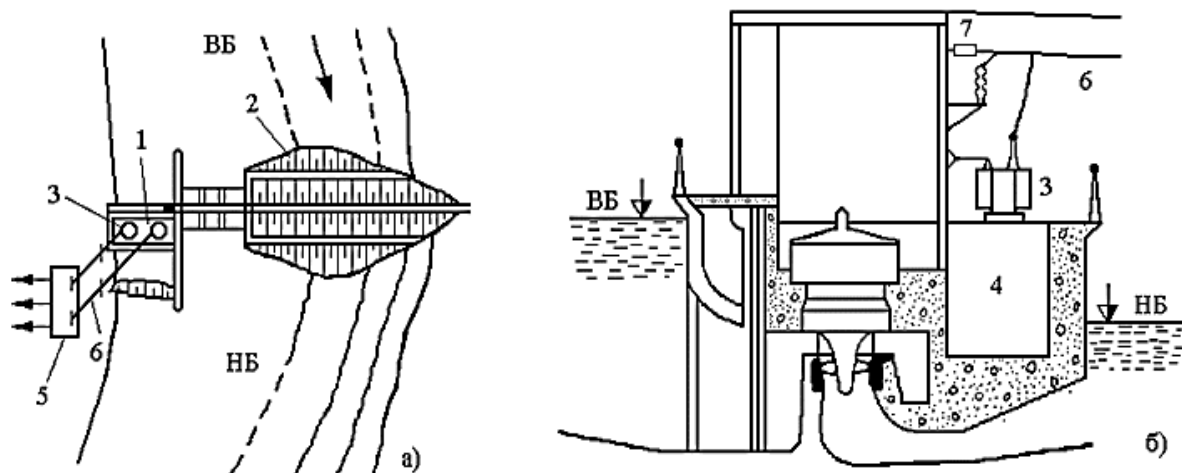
План (а) і поперечний переріз (б) ГЕС, розташованої на руслі
